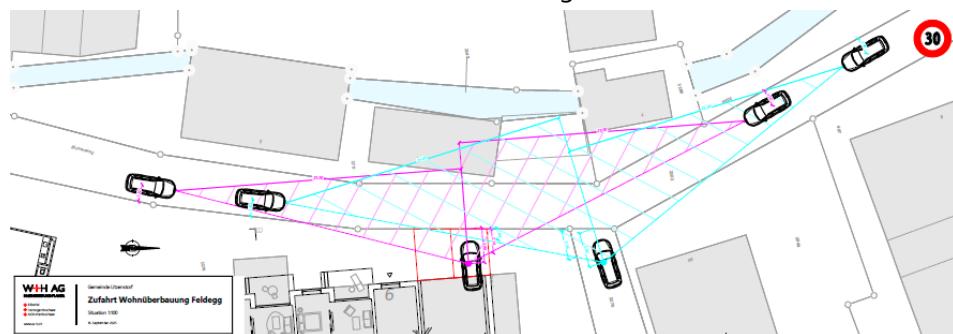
Sichtweiten Ausfahrt Einstellhalle und Knoten Blumenstrasse im Detail (W+H AG)
